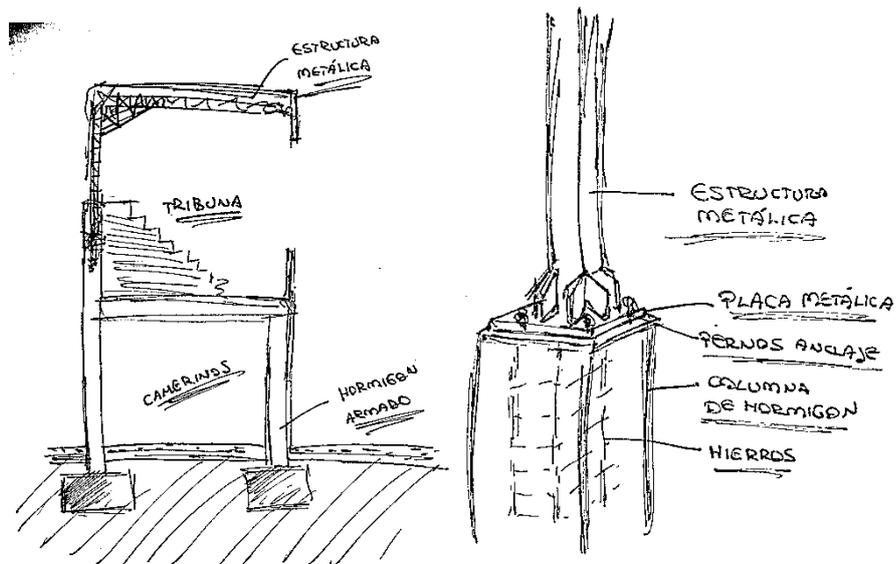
DETALLE ESTRUCTURA MIXTA
